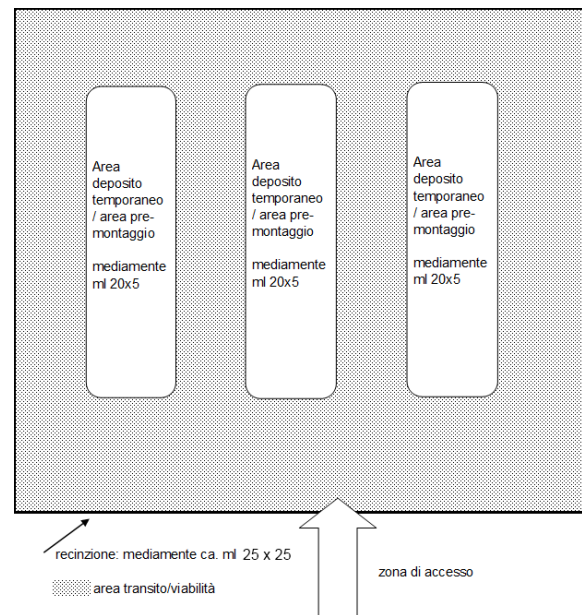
Planimetria dell'Area centrale-Tipologica.
